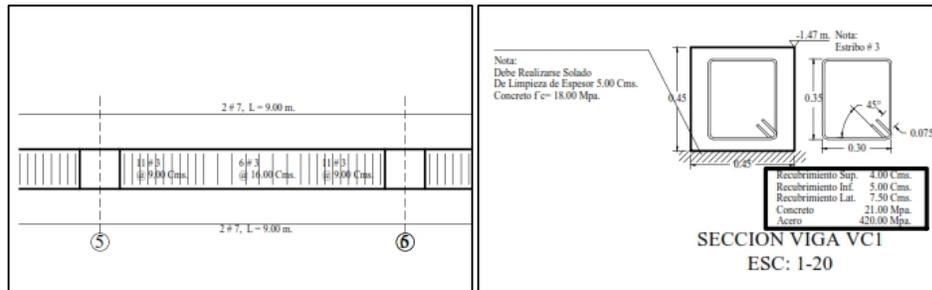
, Detalle vigas A, C, F. Fuente: Constructora Open House.
